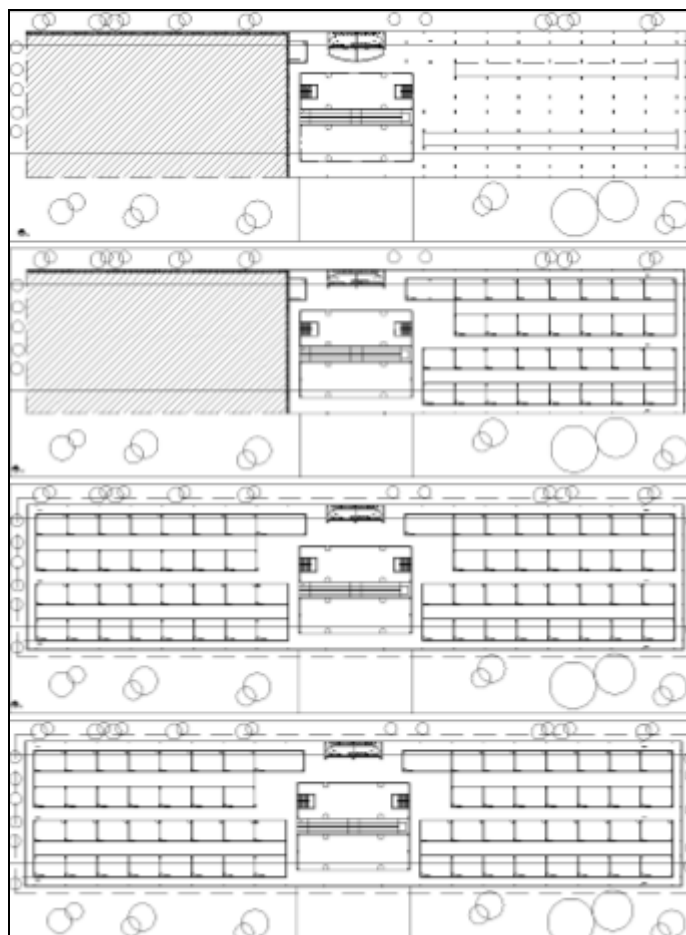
Planta baixa da Central de Integração Acadêmica da UEPB
